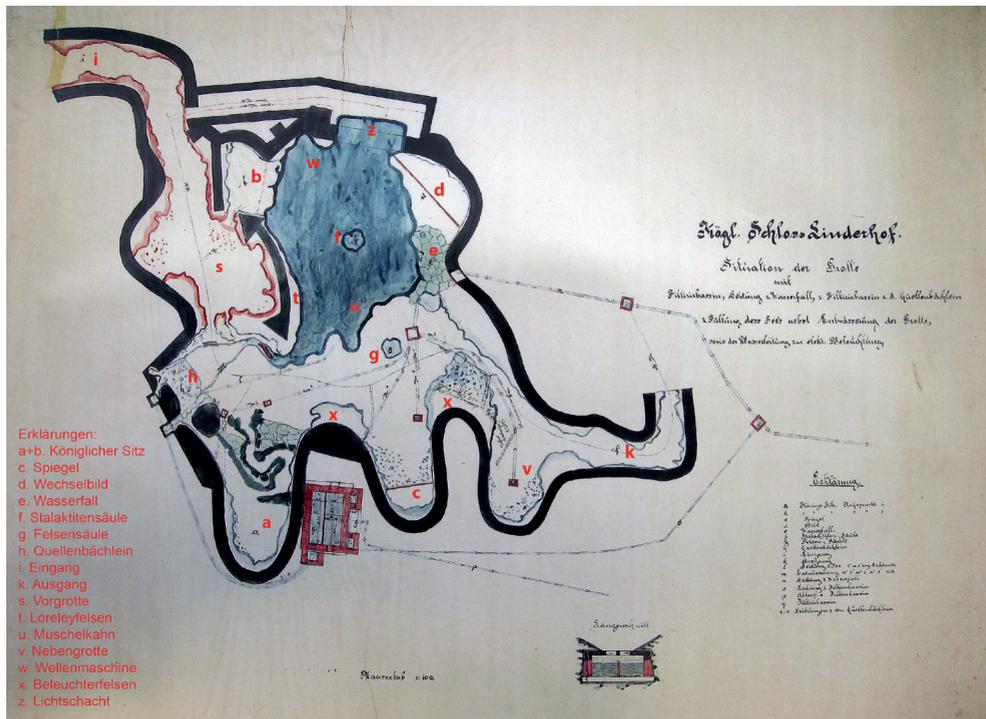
Venusgrotte Schlosspark Linderhof, Grundriss mit eingetragenen Stationen, Bayerische Schlösserverwaltung, Planarchiv der Bauabteilung, LI.00.04.00002.
